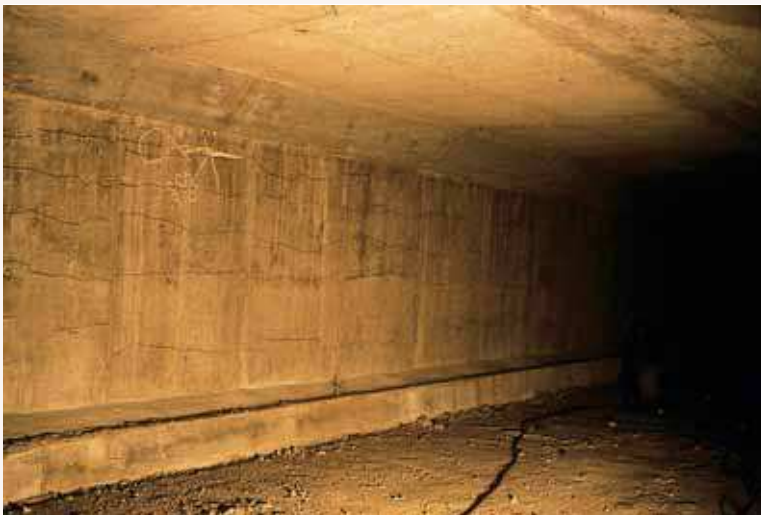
Fissuration d'une âme à l'intérieur du caisson du PI103.
